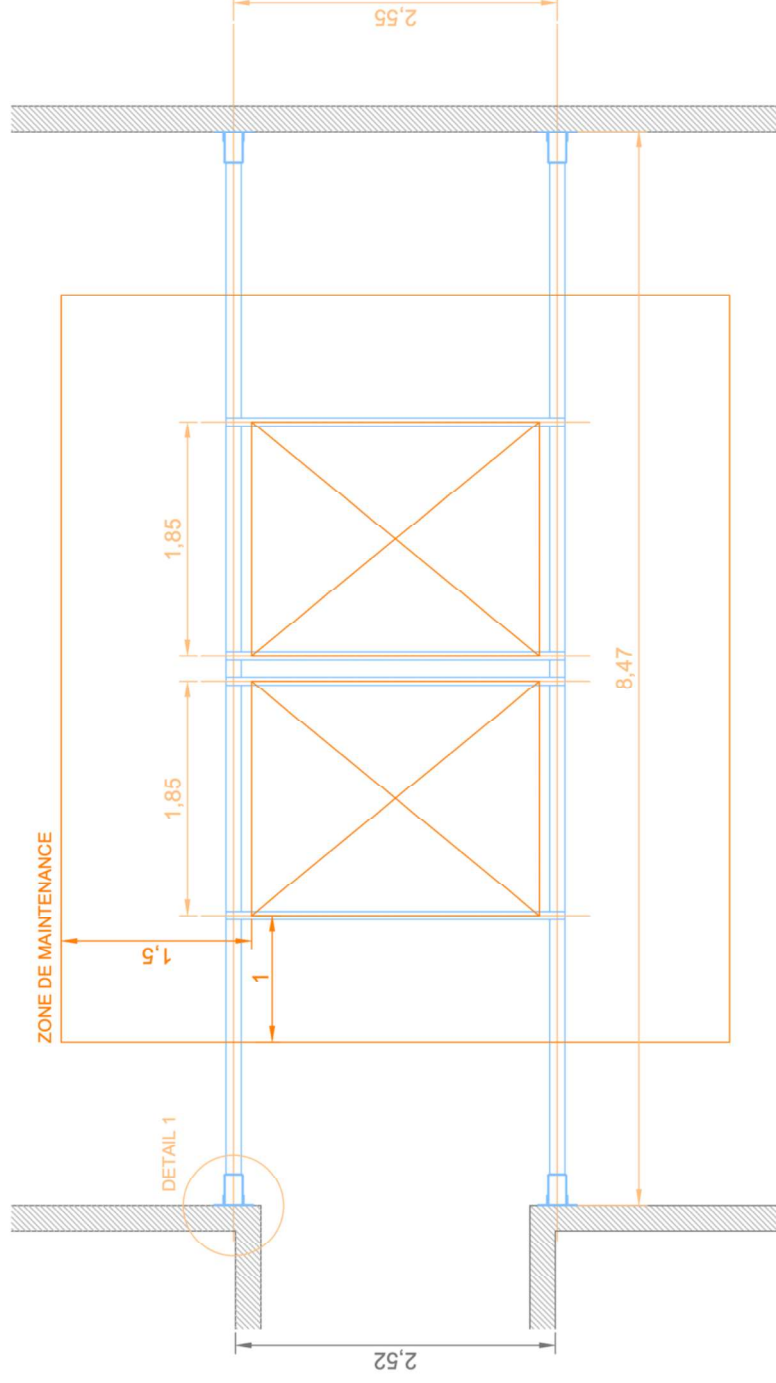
Plan de principe de l'installation des PAC et traverses support.
